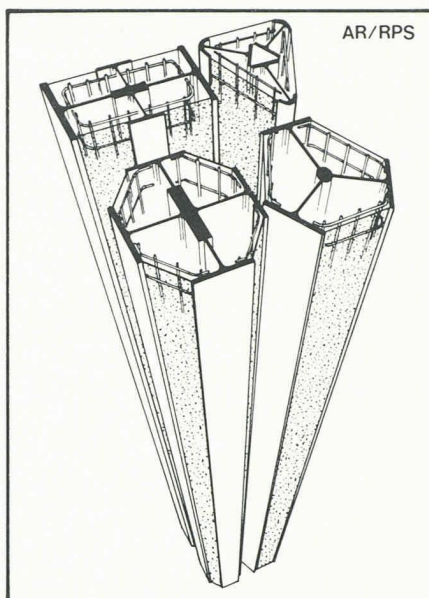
Colonnes mixtes à sections transversales polygonales avec surfaces en acier visibles.
